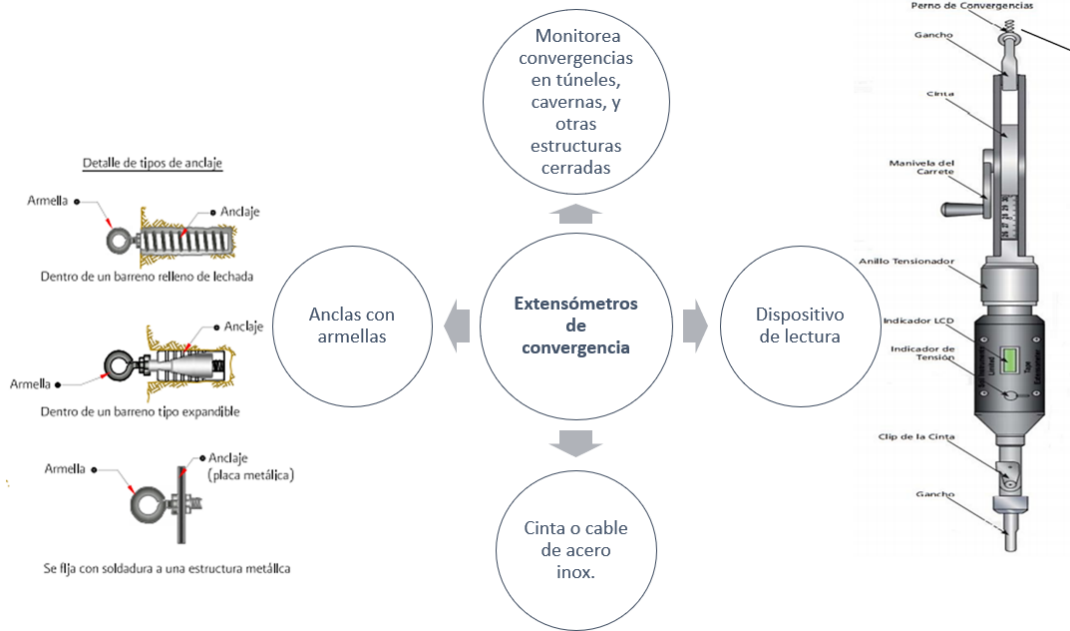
Componentes de extensómetro de convergencia e instalación.
